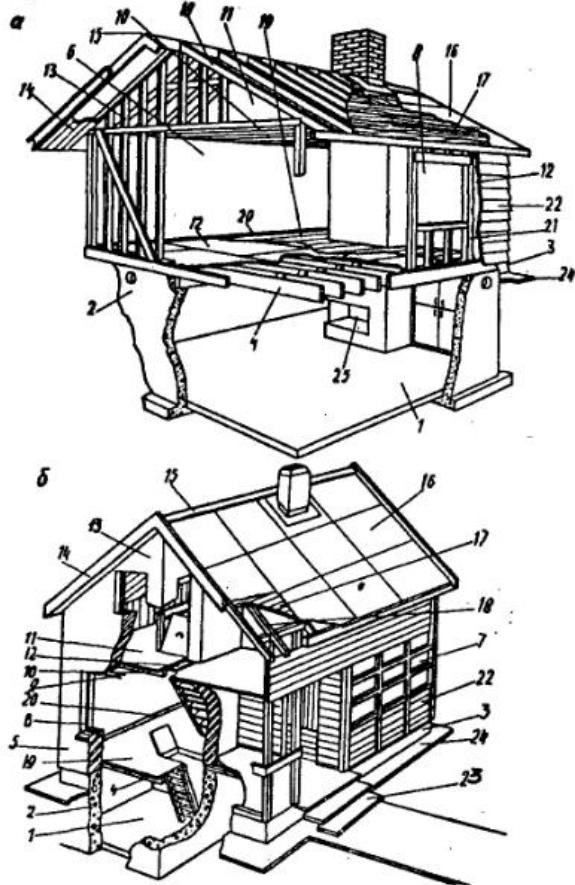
Конструктивные схемы: а — одноэтажный домик деревянно-каркасной конструкции; б — мансардный домик с каменными стенами. 1 — погреб (подвал, подполье), 2 — фундамент; 3 — цоколь; 4 — цокольное перекрытие; 5 — стена; 6 — стена деревянная каркасная; 7 — веранда; 8 — оконный проем; 9 — перемычка; 10 — междуэтажное (чердачное) перекрытие; 11 — мансарда (чердак); 12 — утеплитель; 13 — фронтон; 14 — карниз; 15 — конек; 16 — кровля; 17 — обрешетка; 18 — стропила; 19 — пол; 20 — плинтус; 21 — пергамин; 22 — отделочные доски стен; 23 — крыльцо; 24 — отмостка; 25 — печь.
